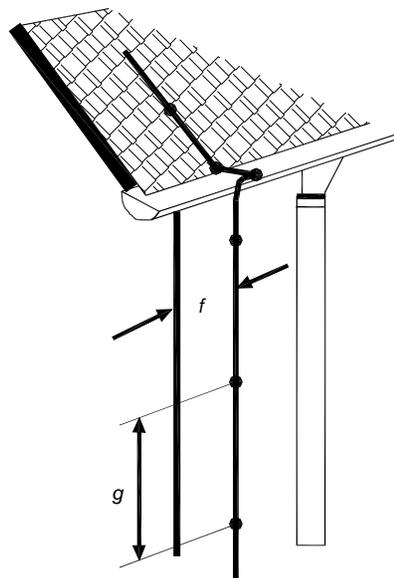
Instalación de un conductor de bajada con conexión a la cañería de desagüe
